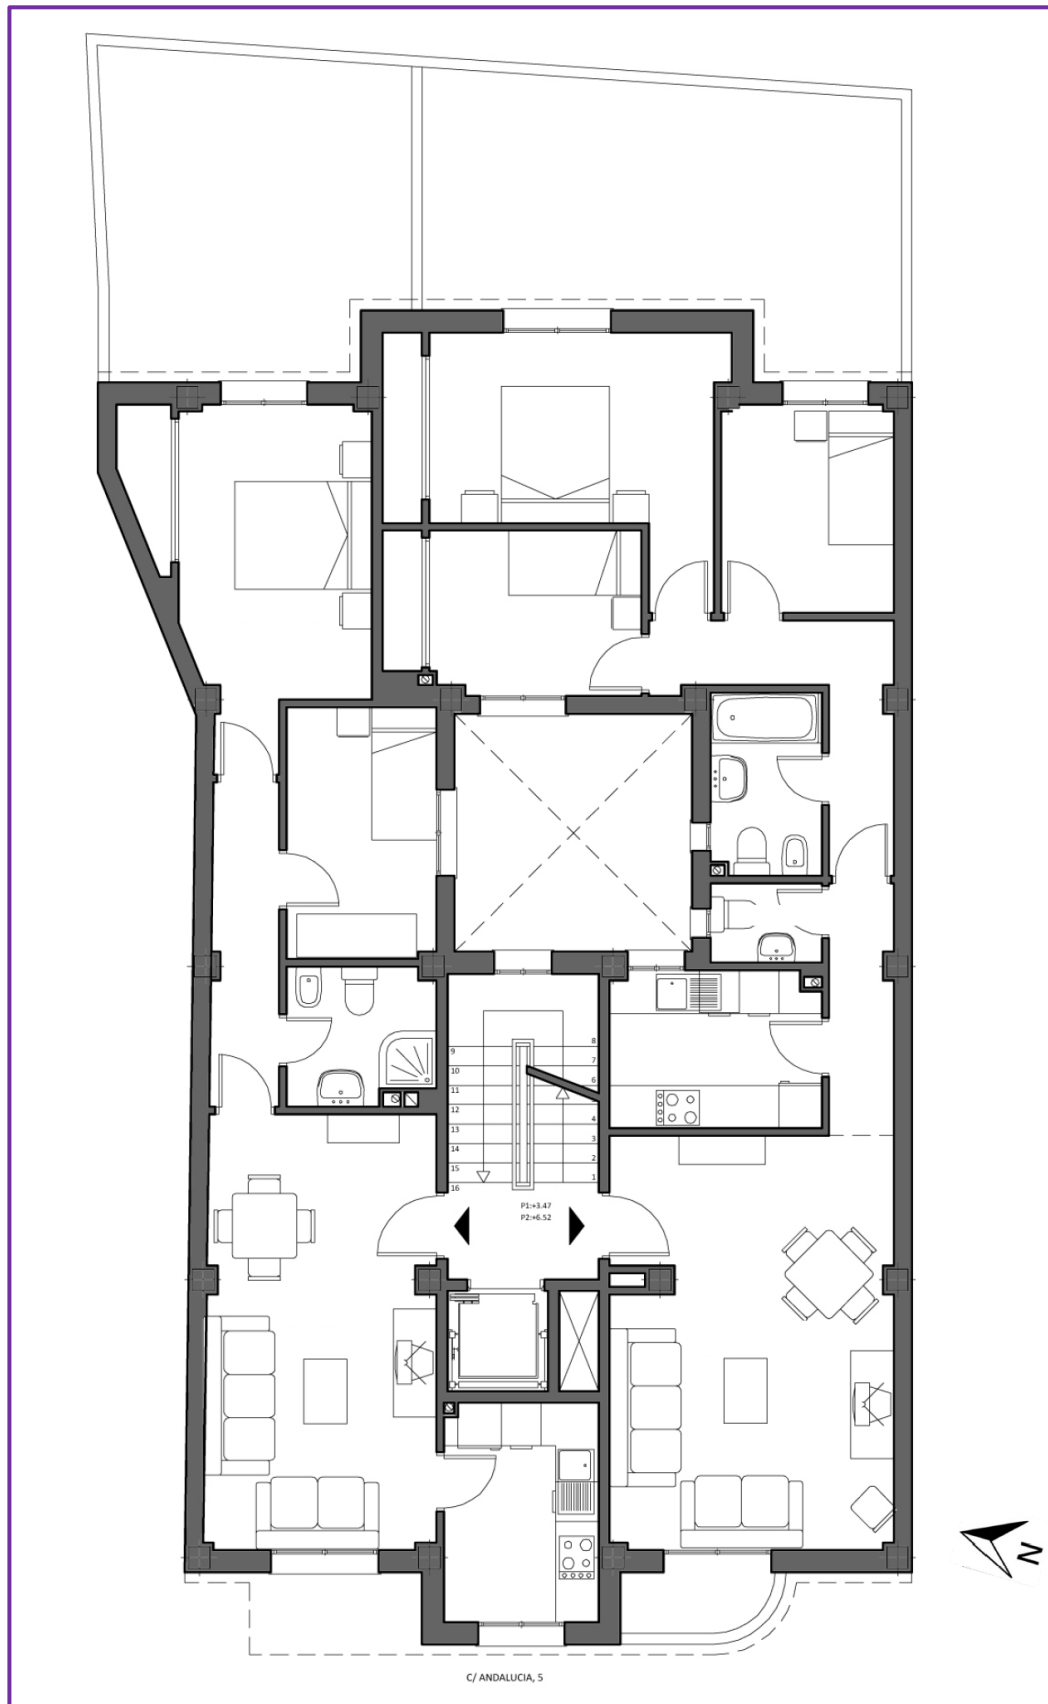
Plano de planta primera y segunda (Fig.4.9 de Facchini, 2014)
